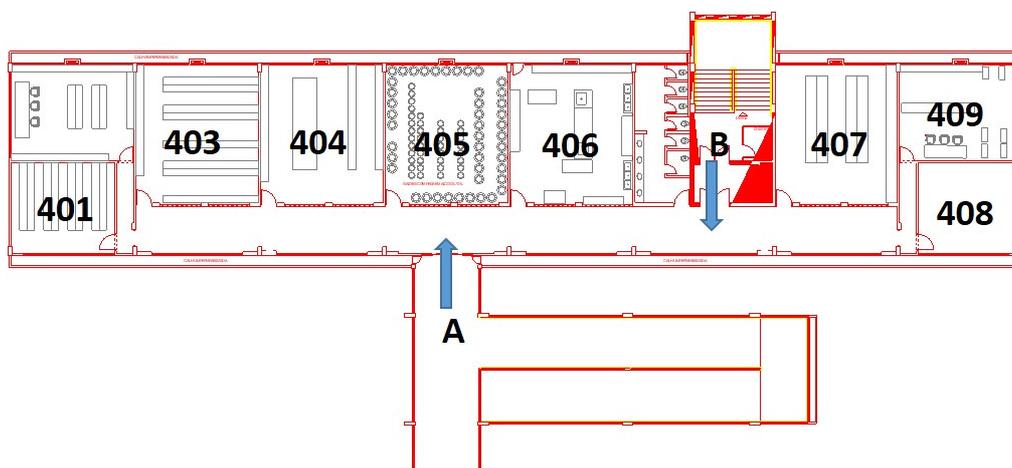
Planta baixa do pavimento 4 com a configuração e números das salas de coleção do MOVI.
